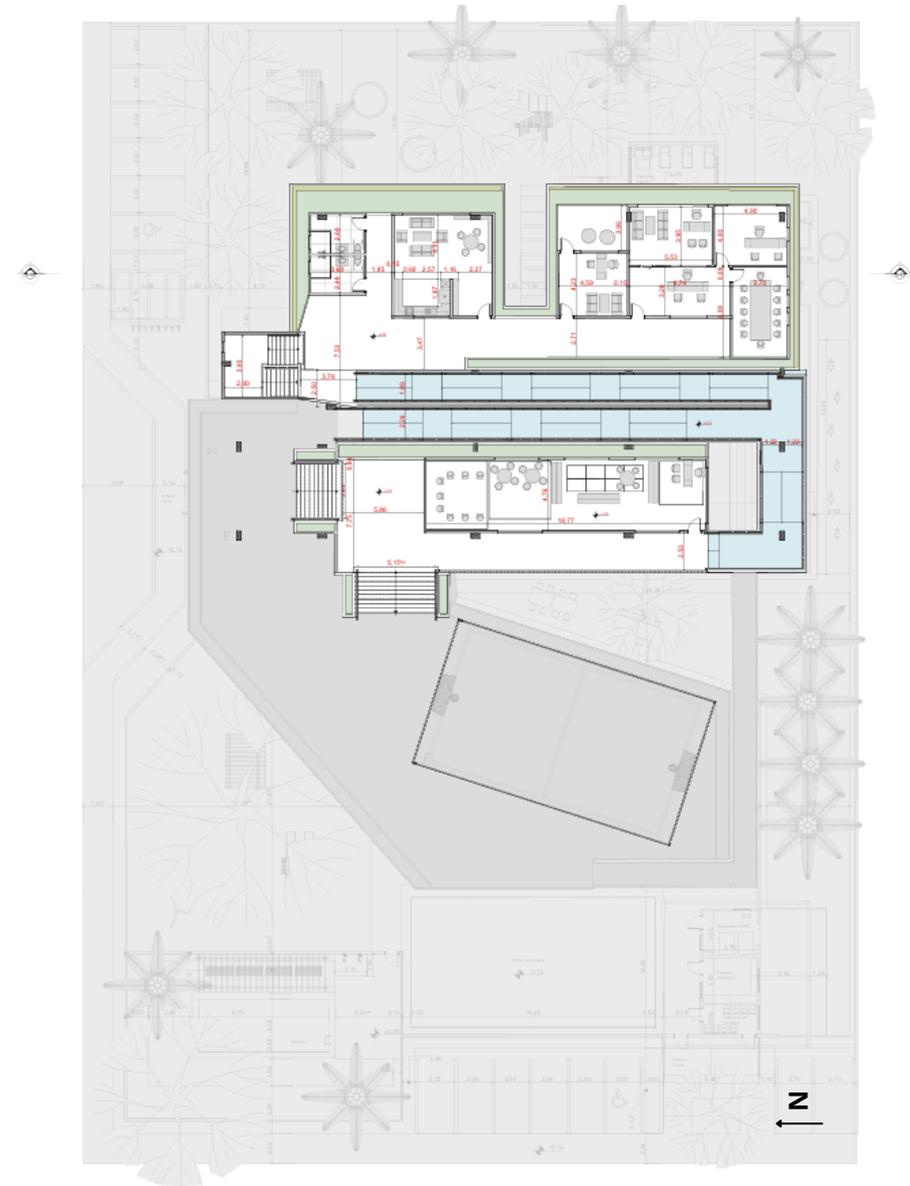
Planta baixa Pavimento Mezanino 2 e Térreo +2
